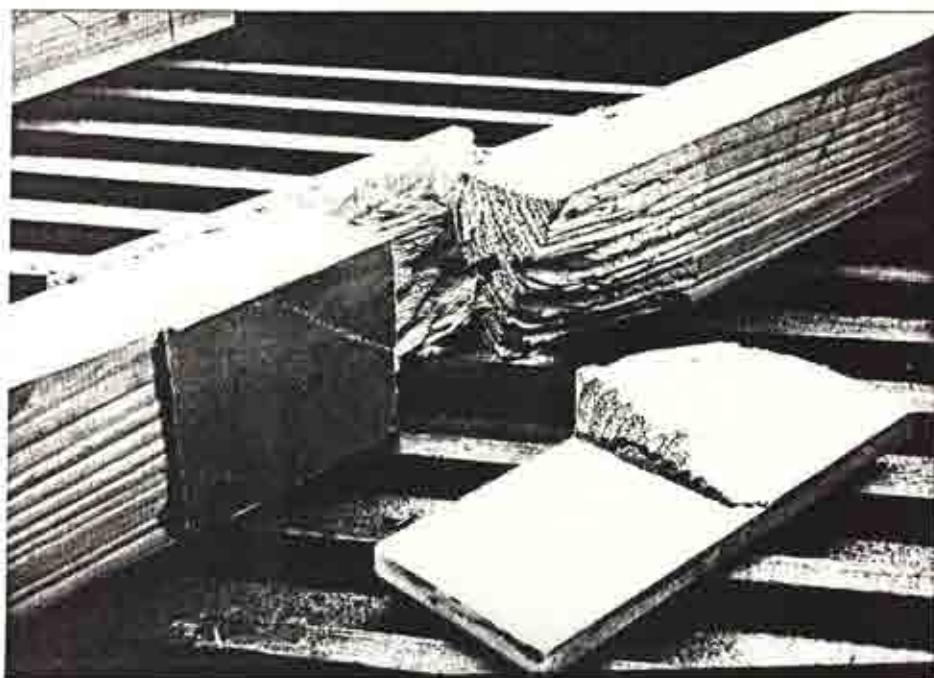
Detalle de la rotura del anclaje de una placa adosada a una viga. Se observa como el fallo viene dado por cortante de la madera y por despegue de la placa en el otro lado.
